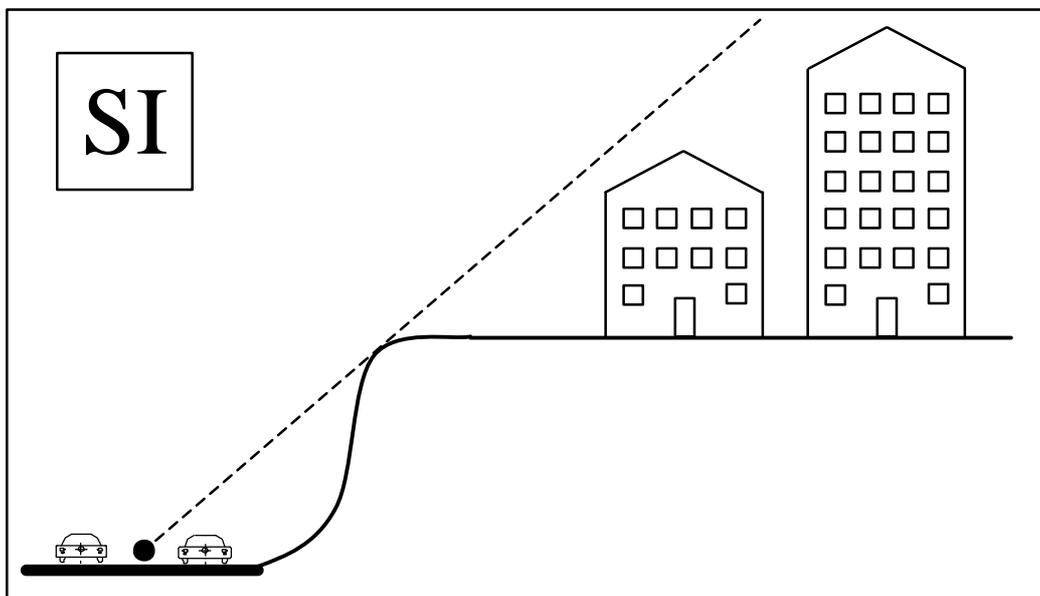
Sezione verticale riferita alla planimetria di figura I4. L'altezza delle costruzioni rispetto al piano stradale e la loro distanza dalla sede viaria sono tali da garantire una copertura acustica ai ricettori.
